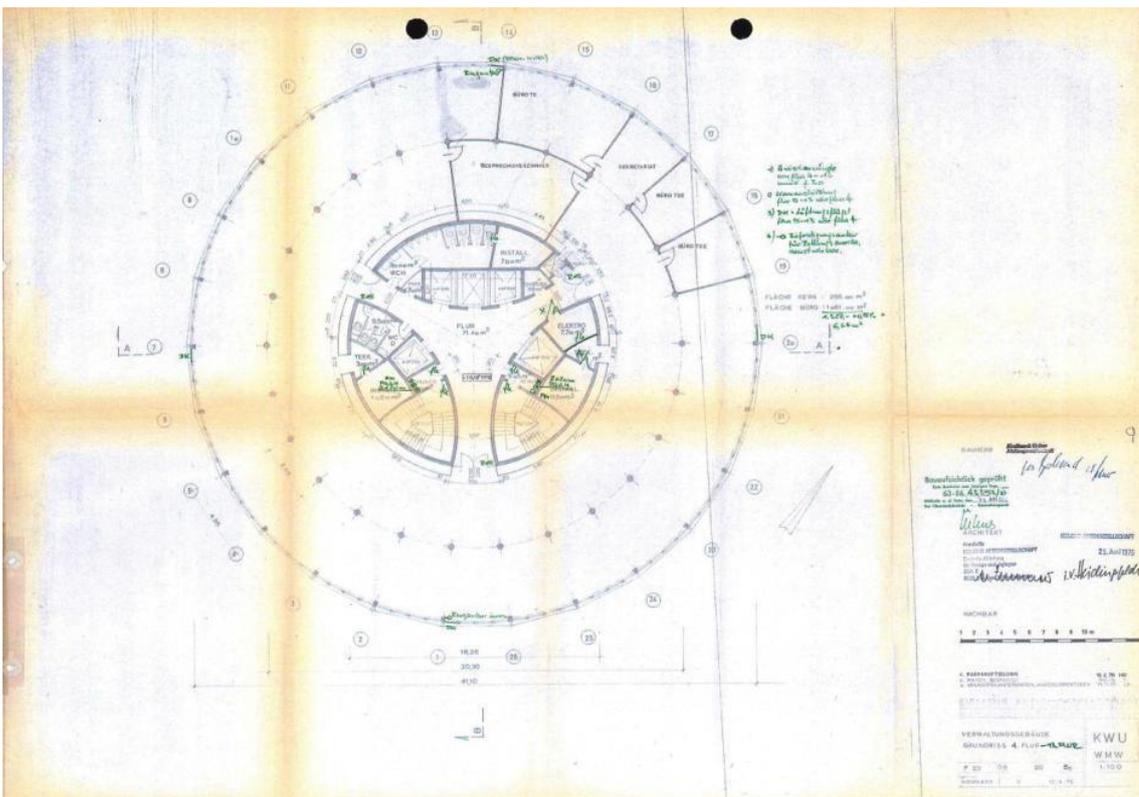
KWU-Gebäude, Grundriss Bürogeschoss, Bauakte
